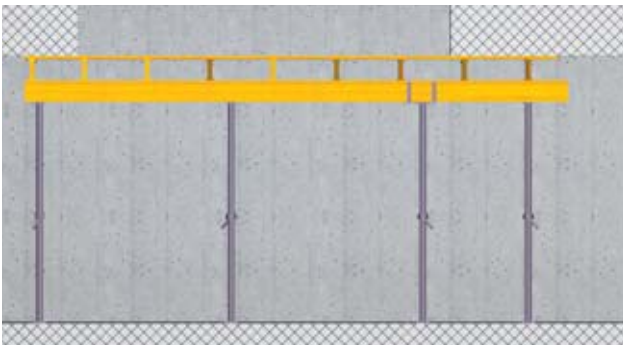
Schliessen der Deckenöffnung mit einem Fanggerüst
